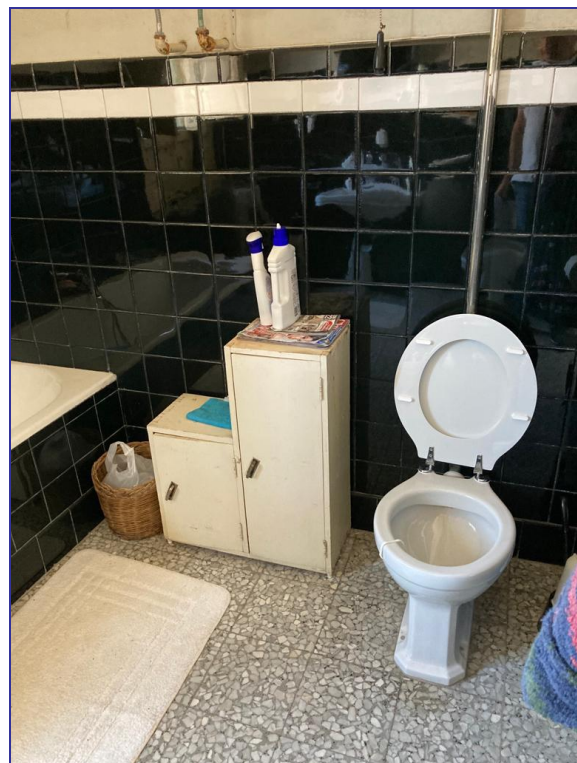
Imm. 4 – Piano secondo - Bagno.
